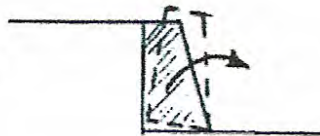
Muro di sostegno: Verifica al ribaltamento
